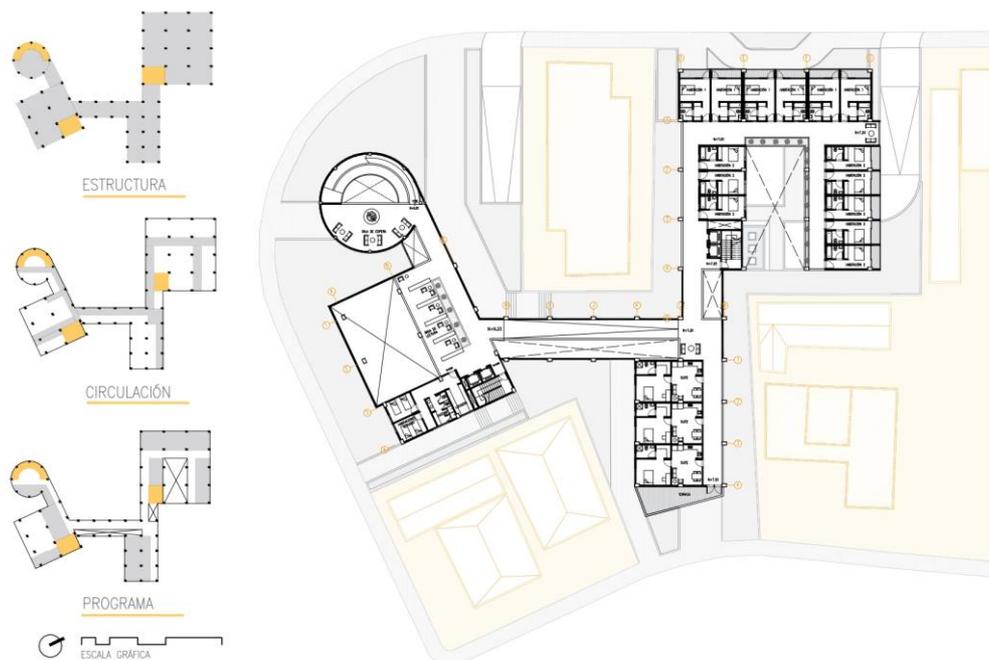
Planimetría: Planta alta 2 (N+7.20). Elaboración propia.
